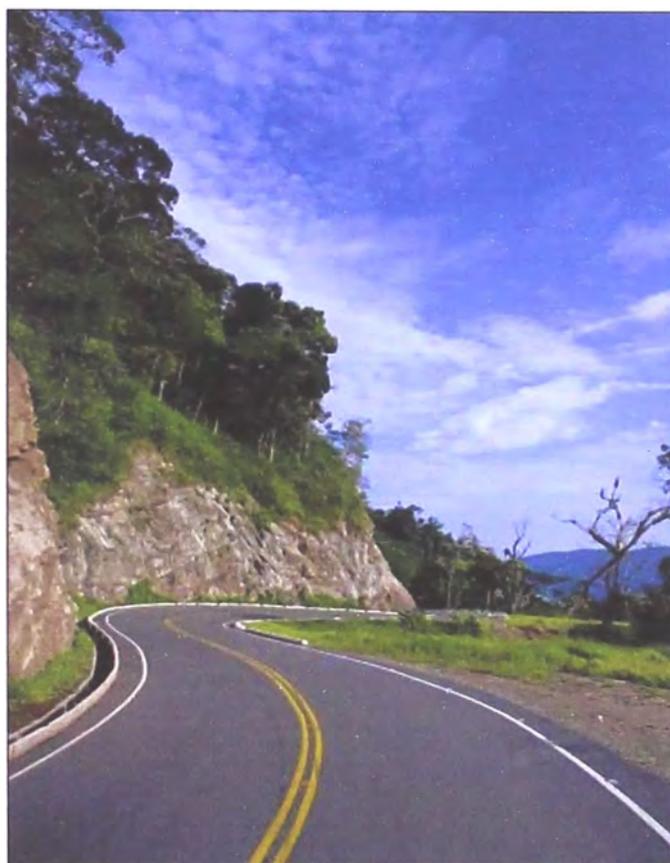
Vista 2 de la IIRSA Norte
